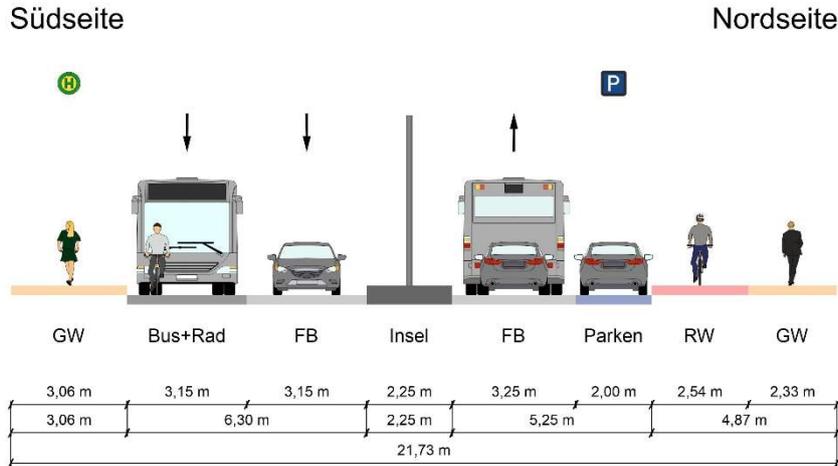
Querschnitt F-F Prüfeninger Straße Bestand nach Abschluss Sanierung (Quelle: INOVAPLAN GmbH)
